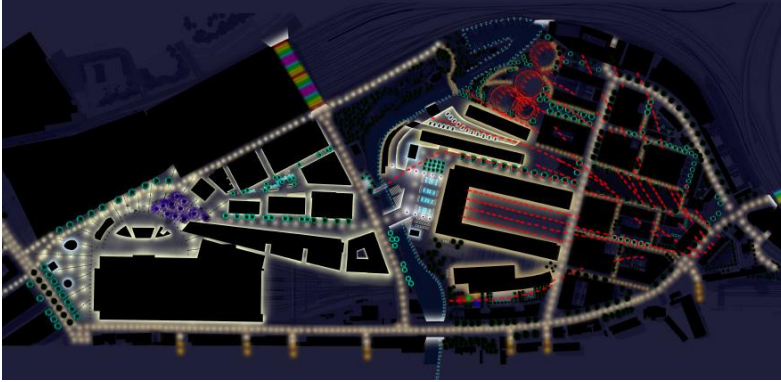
Plano de Iluminação para a *King's Cross Central*, ao lado da Estação de mesmo nome e entorno, em Londres, em Planta Baixa. Projeto do arquiteto Stanton Williams, de 2007.
